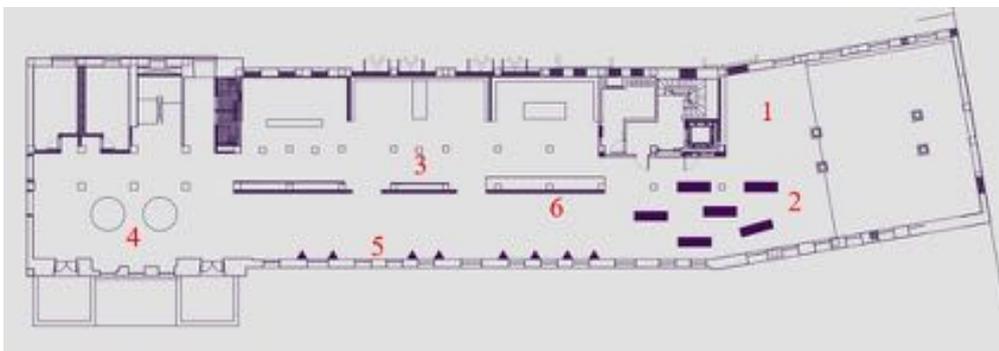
Planta do segundo pavimento da exposição. Exposição “Floresta Protetora”, Parque Nacional da Tijuca. 1 – Recepção do segundo pavimento. 2 – Mesas Interativas. 3 – Conjunto de Módulos. 4 – Espaço Kids. 5 – Divisórias de Triângulos. 6 – Linha Cronológica. (Fonte: Adaptada de Floresta Protetora – Manual espaços expositivos).
